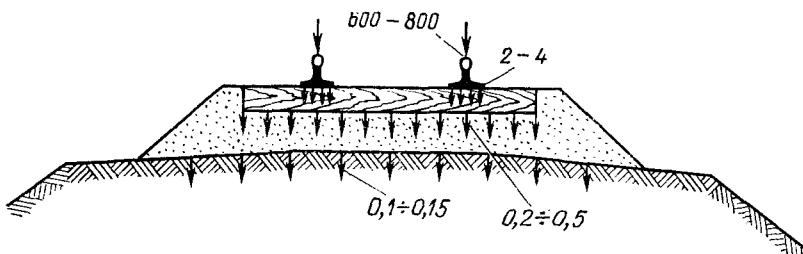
Верхнее строение железнодорожного пути и схема передачи нагрузок
